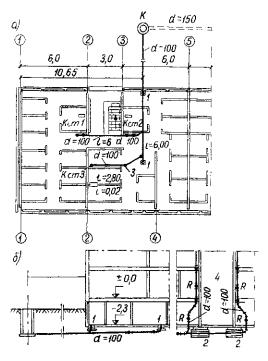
Прокладка канализационной сети ниже пола подвала в крупнопанельном жилом доме с сараями и с несущими поперечными стенами
